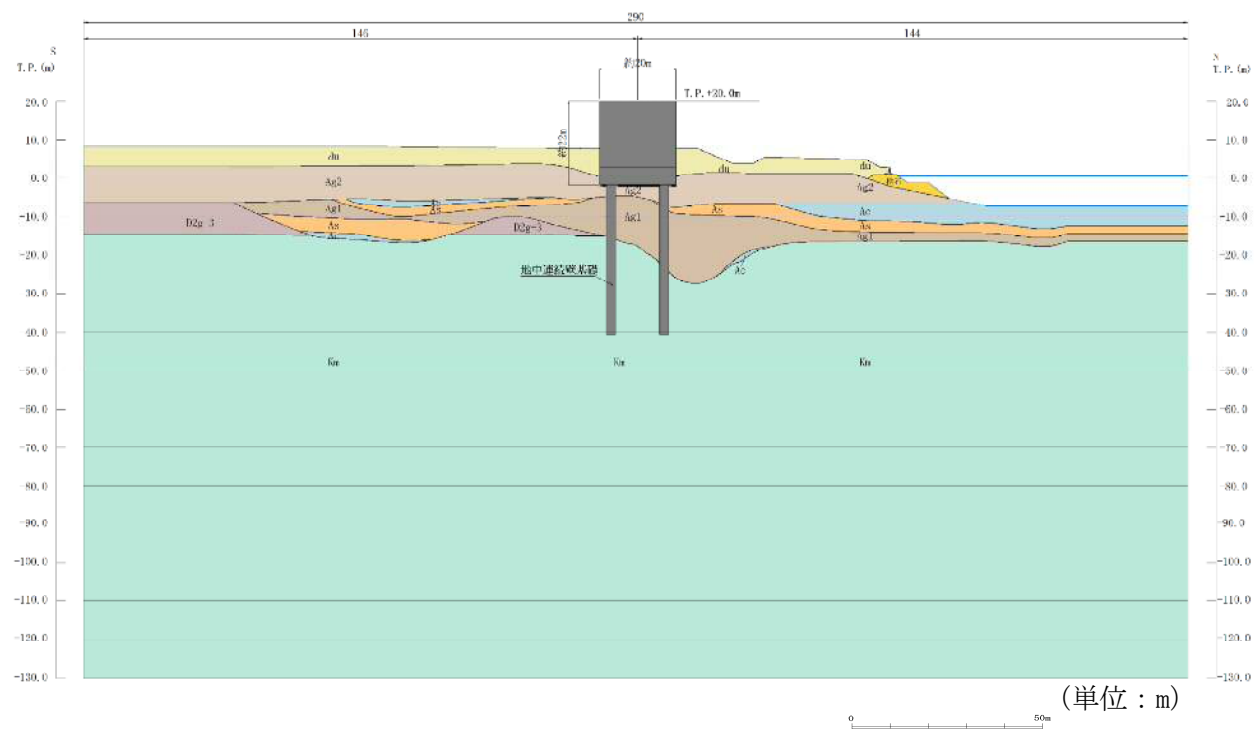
10. 3-3 (2) 鉄筋コンクリート防潮壁 断面図(B-B断面)
